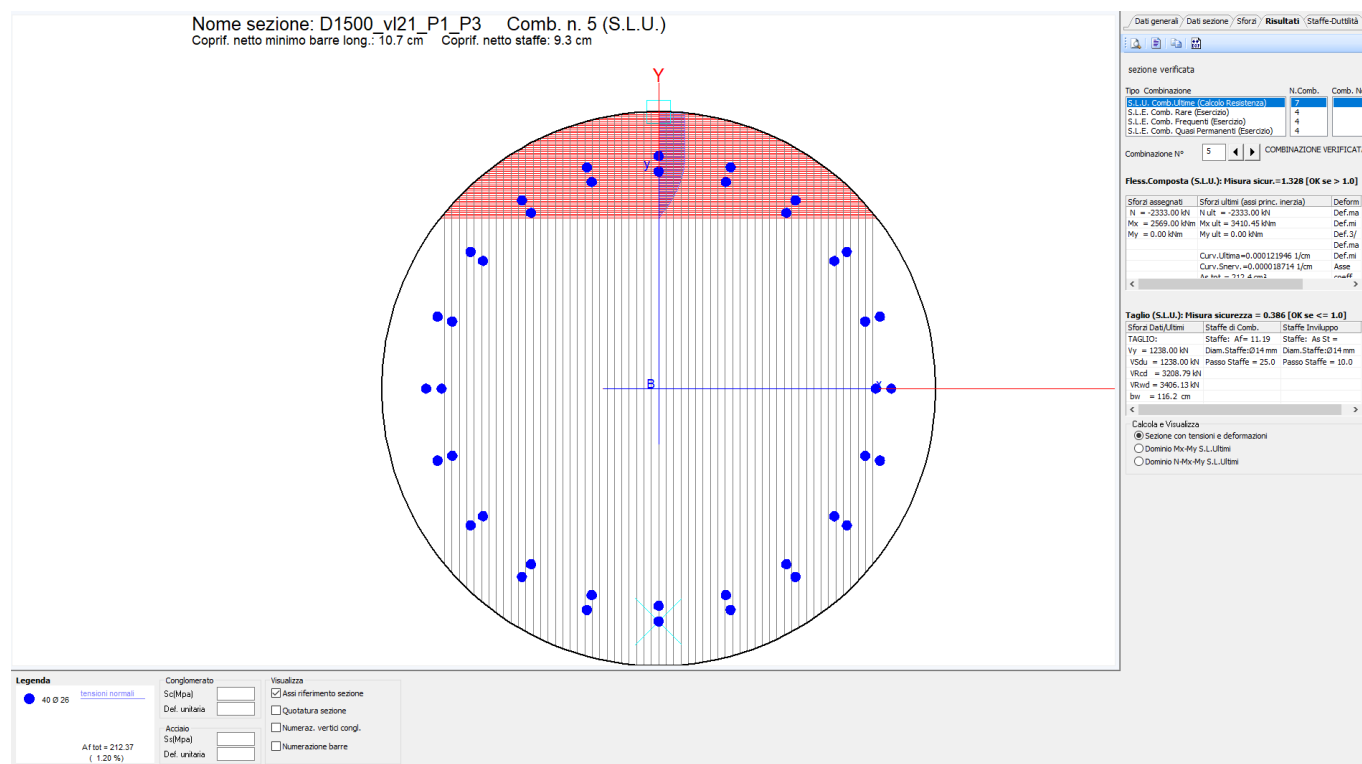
Verifica strutturale palo (Pila 1 e 3)
